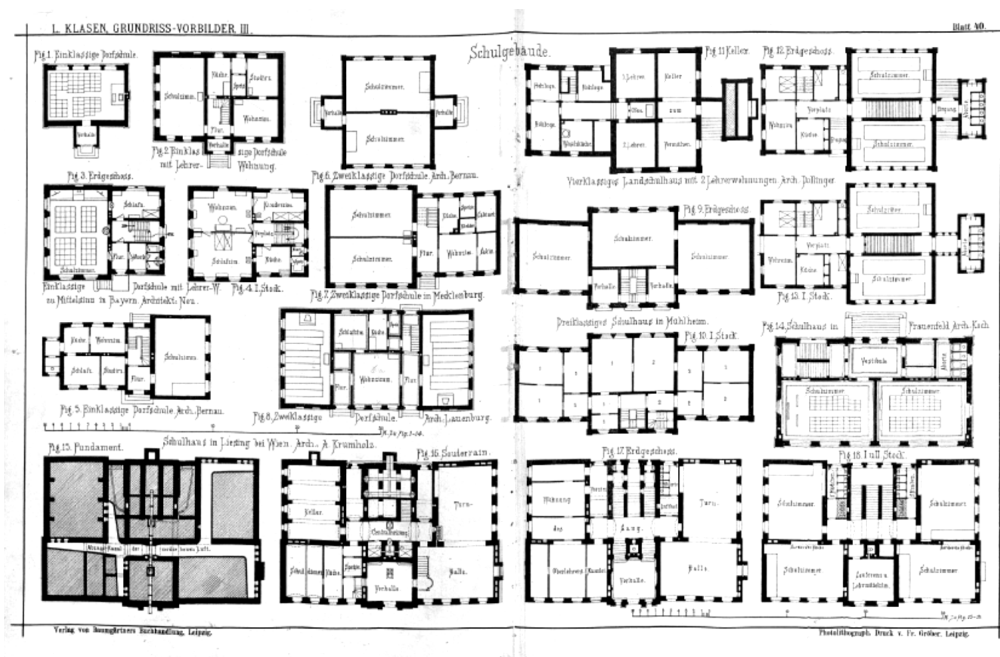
Grundriss-Vorbilder, Blatt 40 (Klassen 1884)²⁶
